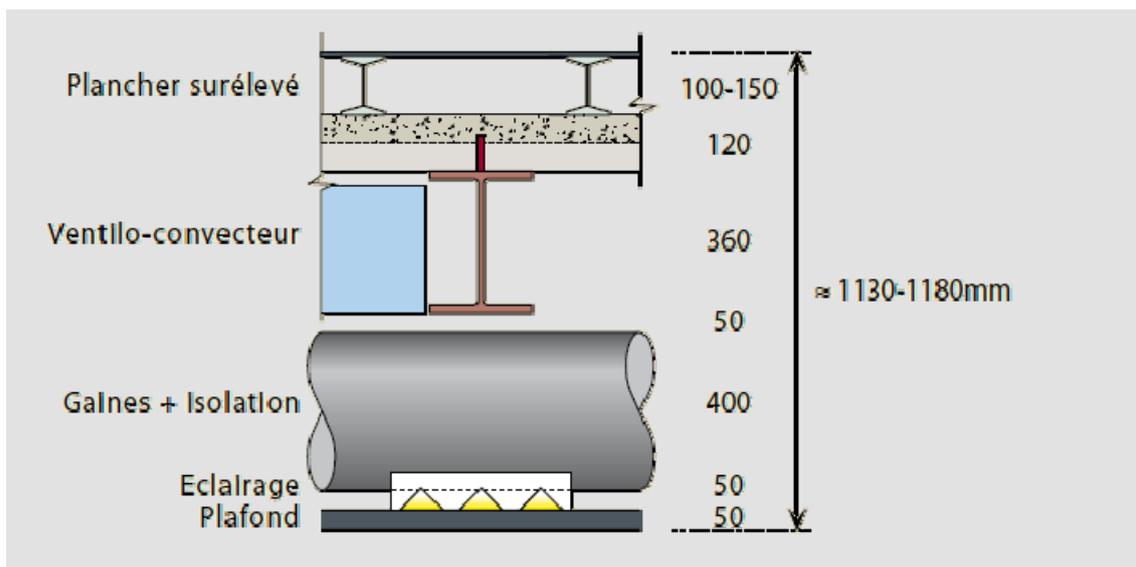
Espace de plancher hors tout – Construction mixte caractéristique pour faible portée
